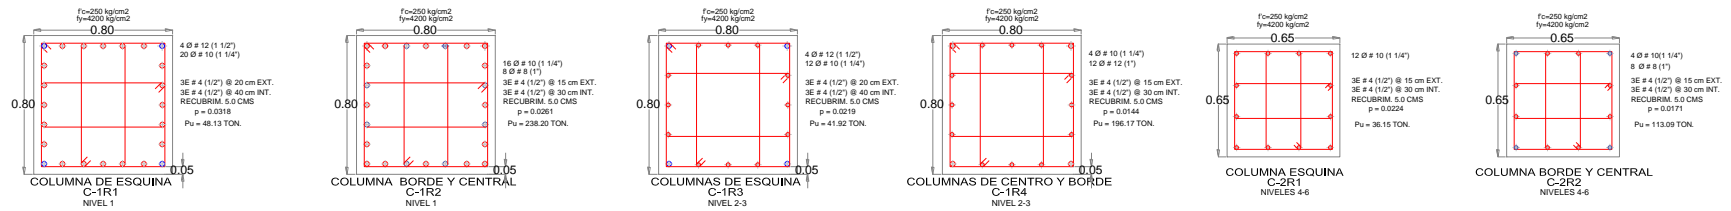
Detallado de armado de columnas de edificio de 6 niveles con base a la hipótesis de las NTCC-04.
